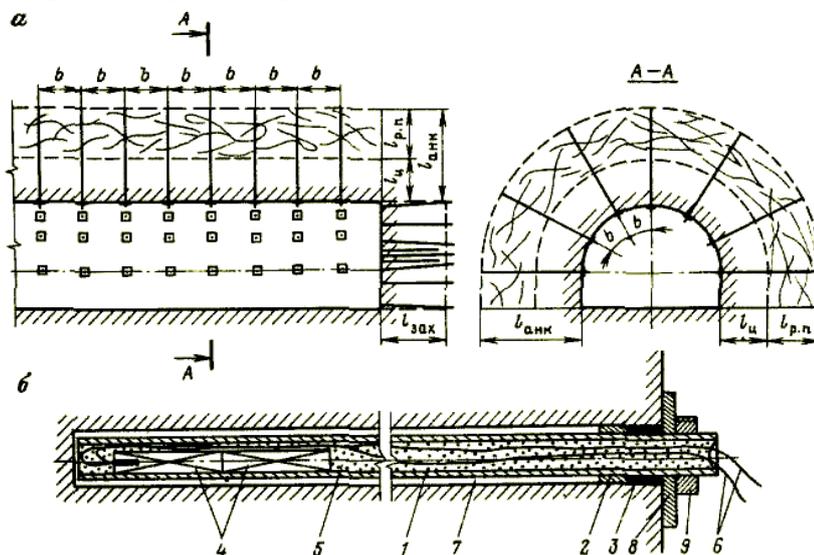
Схема проведения выработки с использованием способа «крепь-охрана» (а) и конструкция заряда ВВ (б): 1 – трубчатый анкер; 2 – гайка стопора пакера; 3 – пакер; 4 – патроны ВВ; 5 – песчано-глинистая забойка; 6 – провода электродетонаторов; 7 – шпур; 8 – опорная плита; 9 – натяжная гайка.
